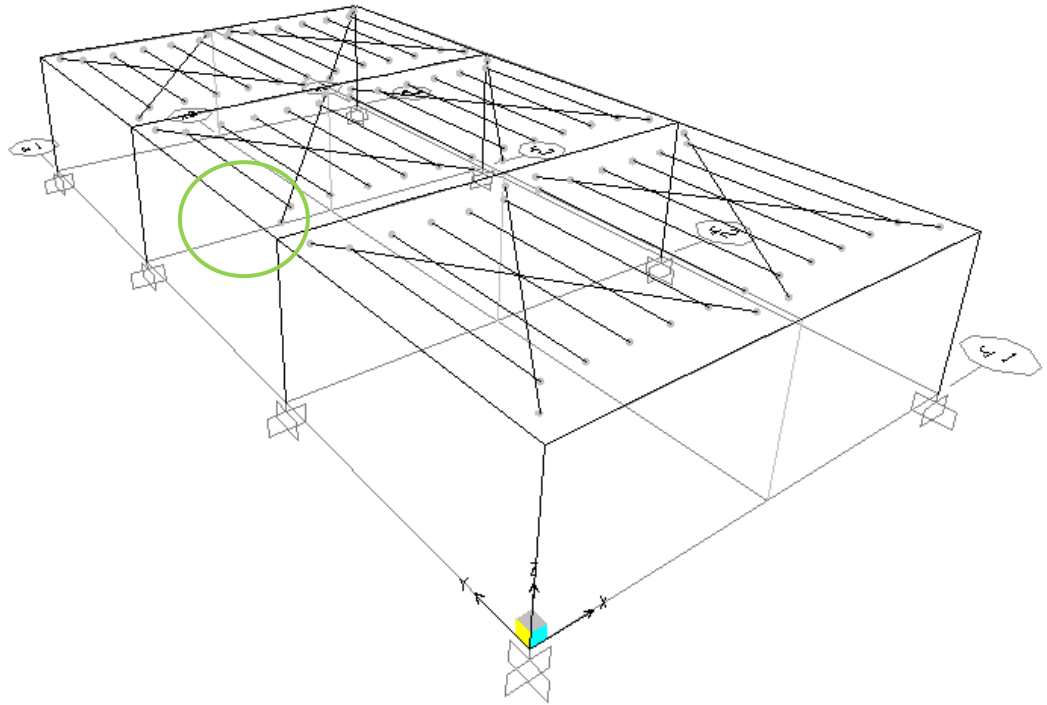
Nave industrial con conexión viga – pilar hormigonada en sitio
